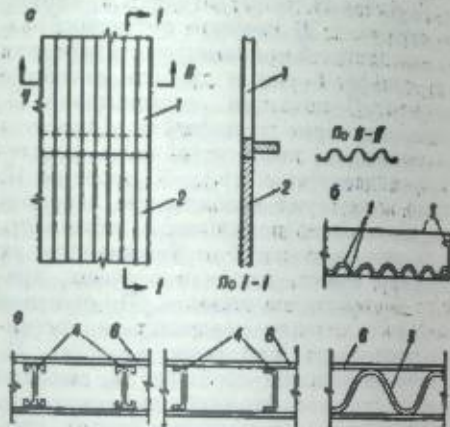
Ограждения стен и кровли из светопрозрачных пластмасс (а — светопрозрачный участок стены; б — стеновая панель с обрамлением из алюминиевых профилей; в — трехслойная панель): 1 — волнистый стеклопластик; 2 — волнистые листы из асбестоцемента или металла; 3 — алюминиевое обрамление; 4 — решетка из алюминиевых или стеклопластиковых профилей; 5 — волнистый лист; 6 — плоский лист.
